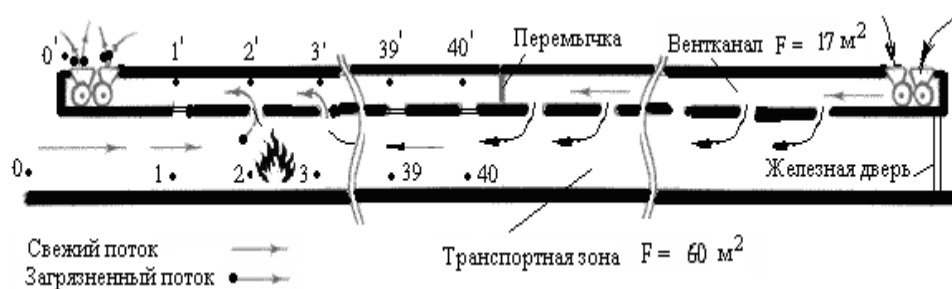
Продольно-поперечная система вентиляции в режиме работы тушения пожара
